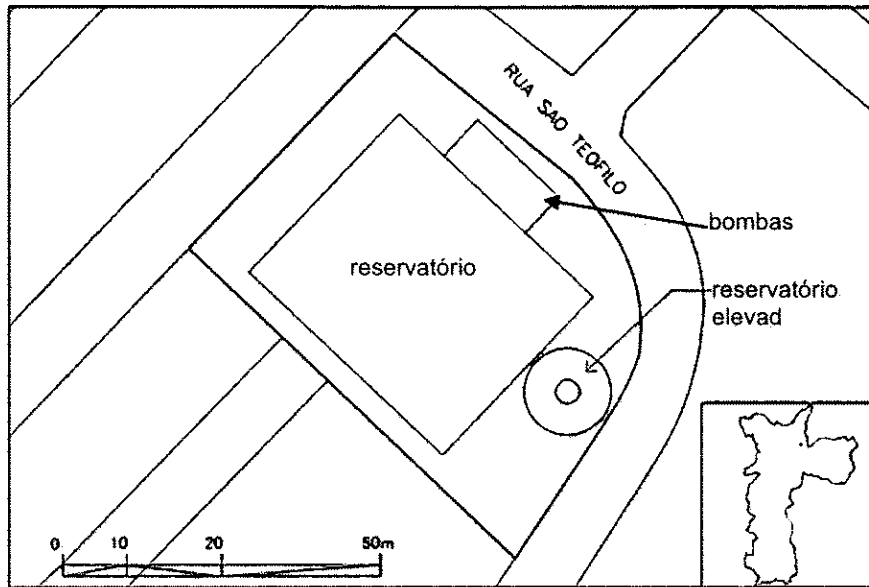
Planta de Estação de Bombeamento de Água Vila Medeiros
